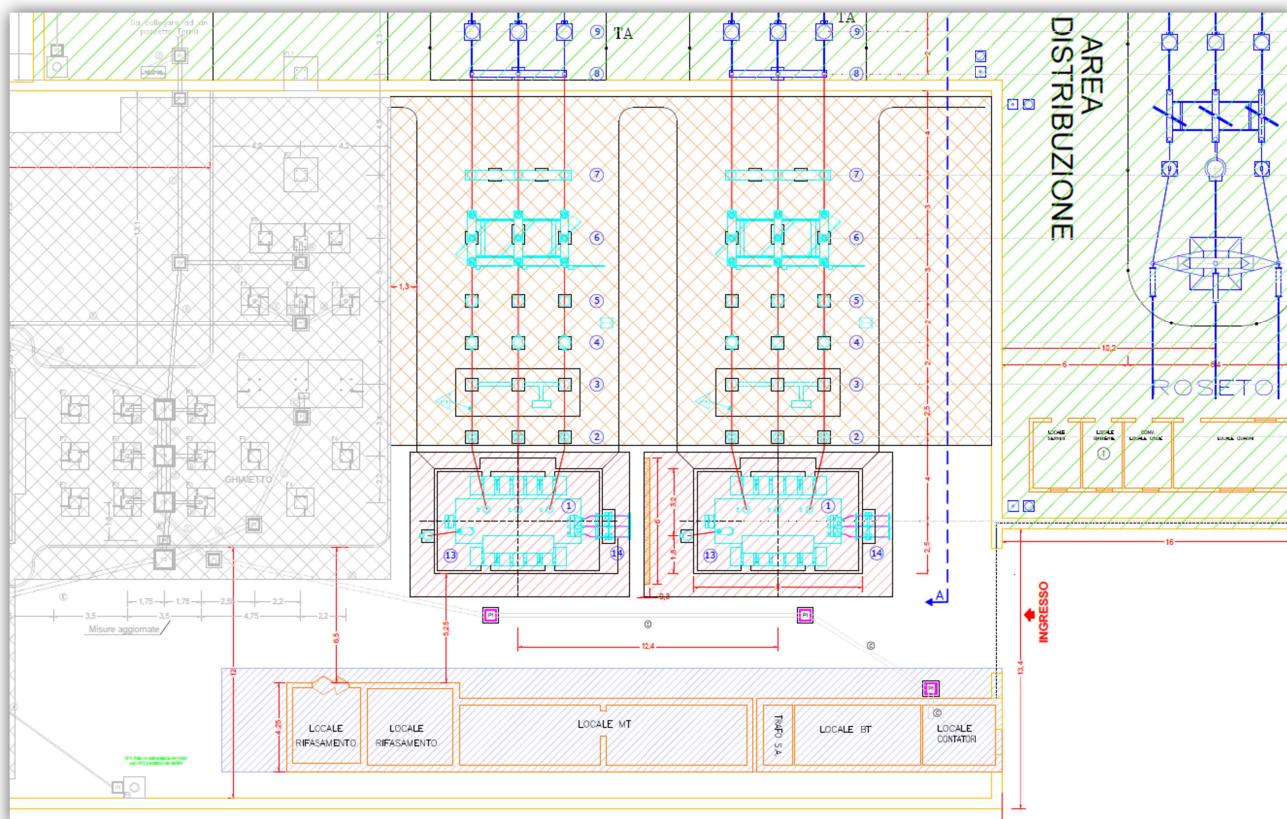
Pianta elettromeccanica di dettaglio della SSE Produttore. Con campitura rossa si è indicata le vasche trafo ed i TRAF0 oggetto di dismissione e sostituzione; con campitura arancio i due montanti esistenti oggetto di dismissione e rifacimento; in basso, i locali tecnici esistenti che saranno demoliti e sostituiti da 2 nuovi manufatti di tipo ad elementi prefabbricati.
